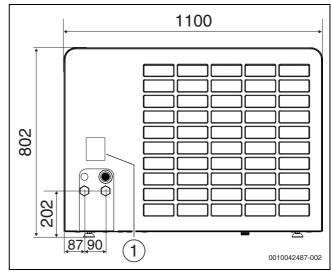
Dimensions et raccordements de la pompe à chaleur, arrière
